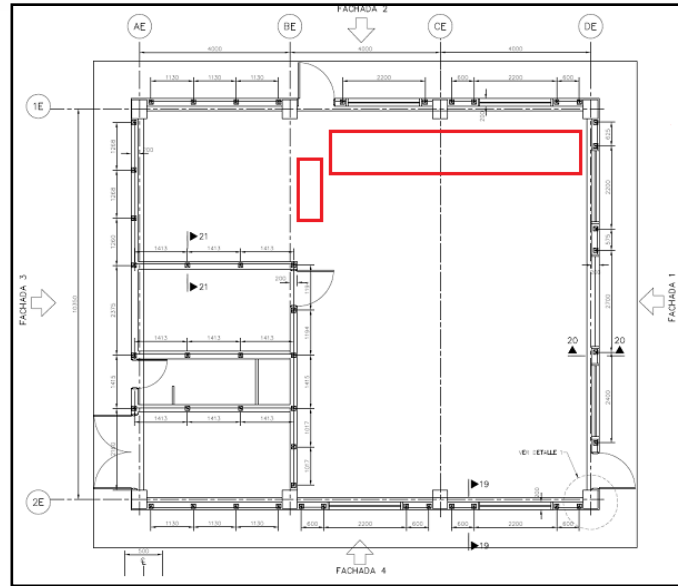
Planta de ubicación de dovelas de refuerzo y anclaje en mampostería
